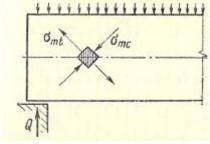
Главные напряжения в бетоне у опоры балки.
